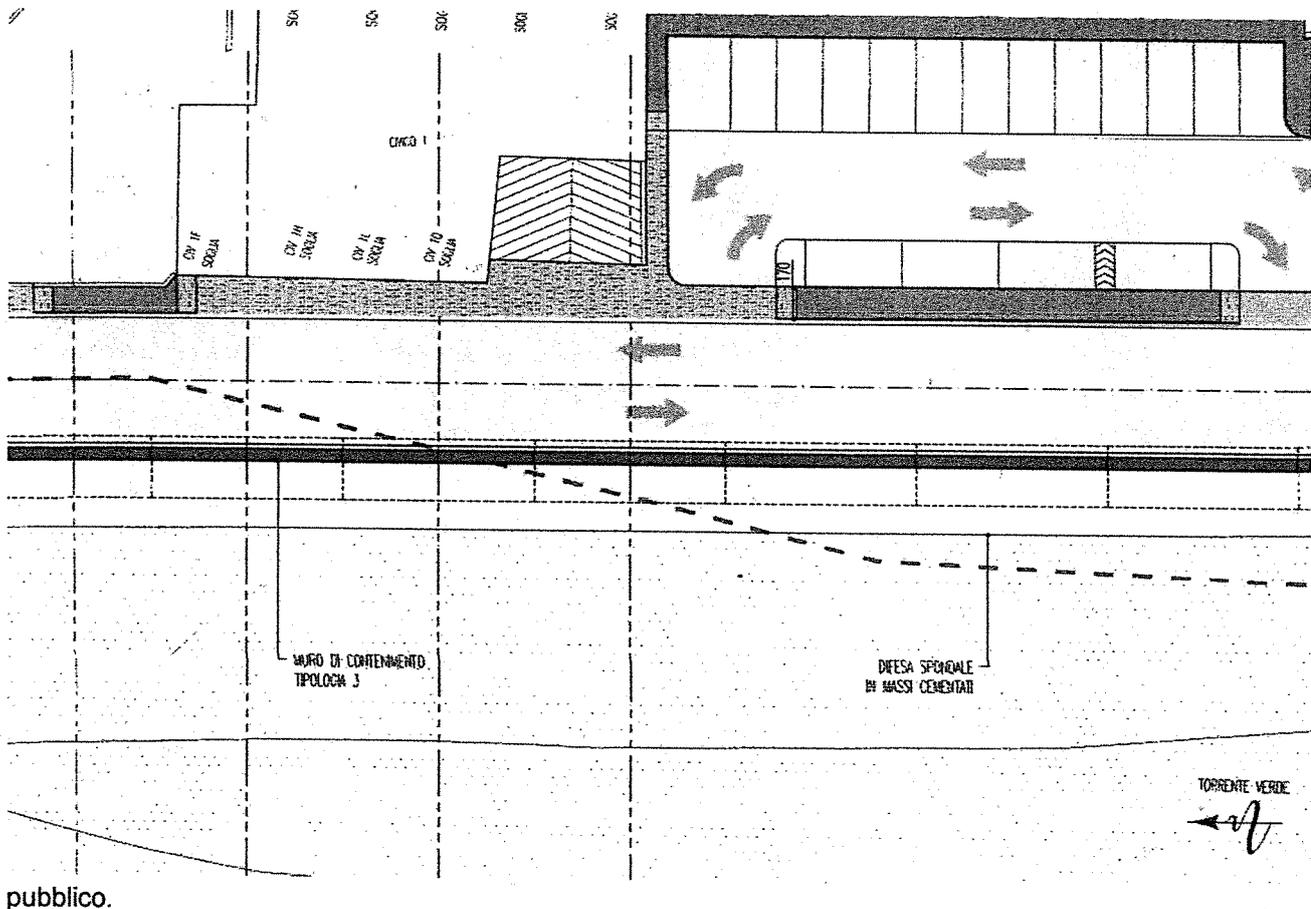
planimetria tratto 3 – edificio Via Lungotorrente verde 1 e nuova area a posteggio
